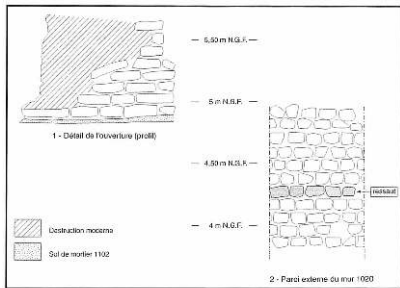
Plan de détail de l'appareillage du mur 1020
